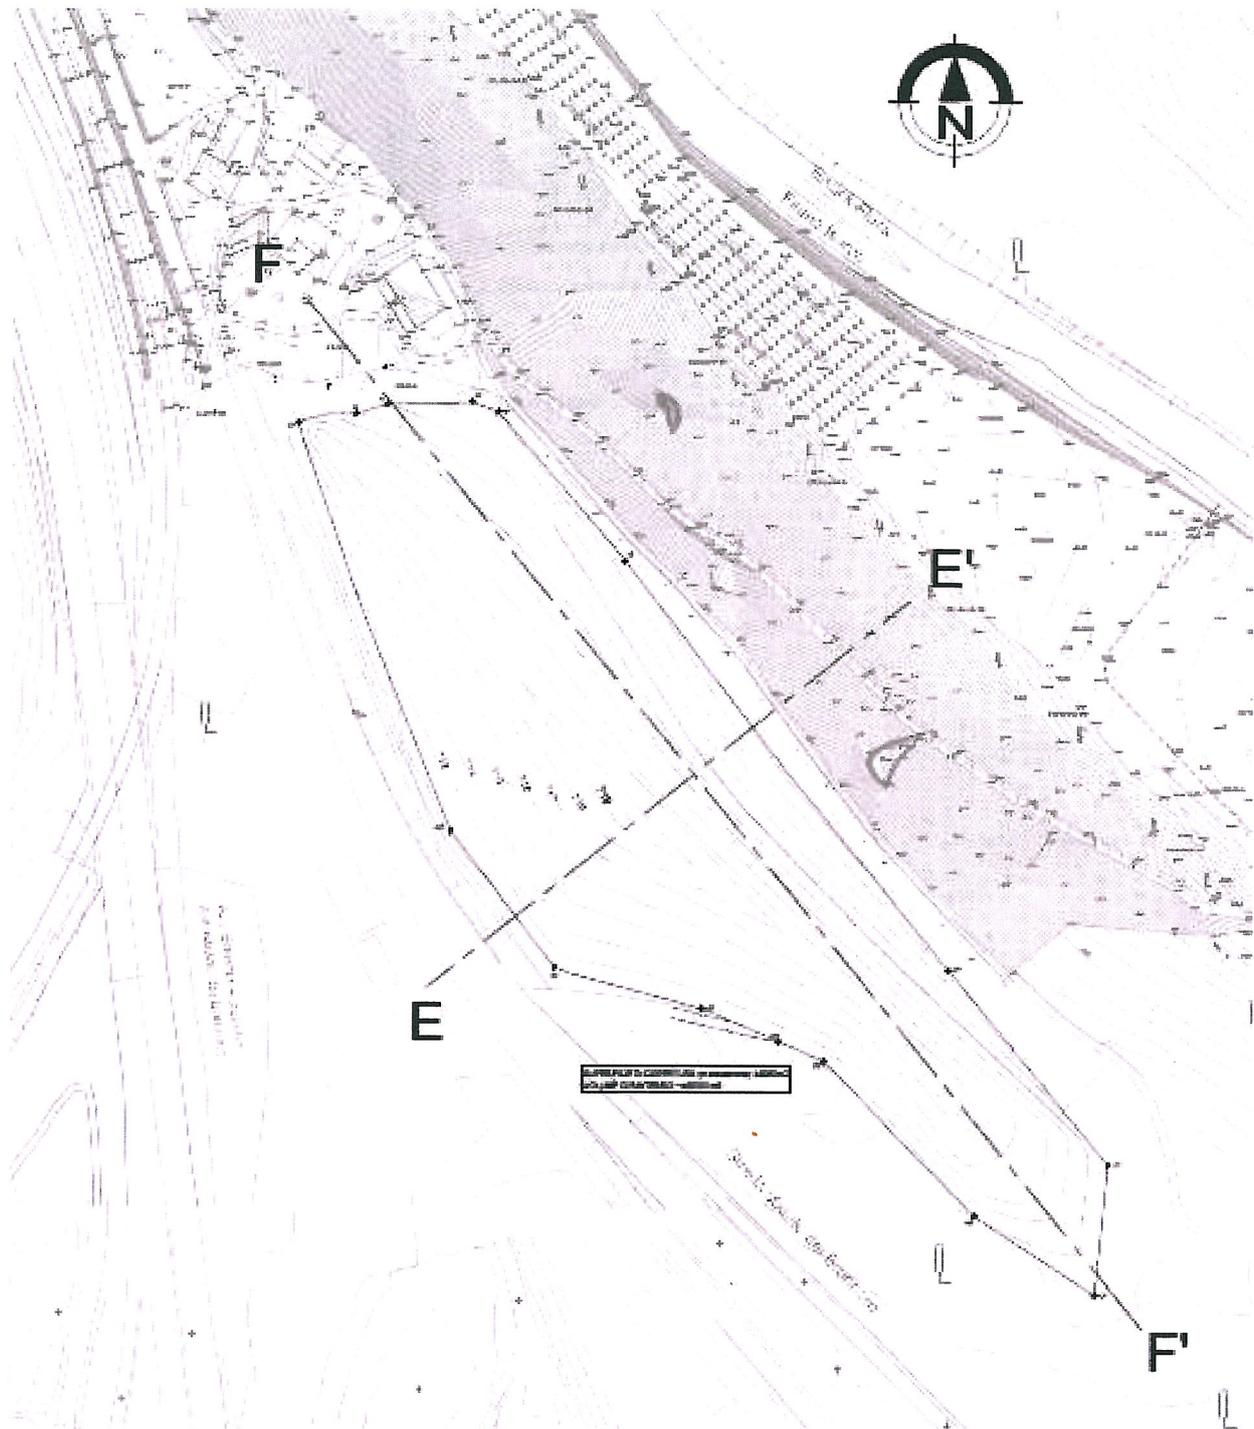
Depositi definitivi in Val Riga - C - Plattner - Planimetria di progetto
